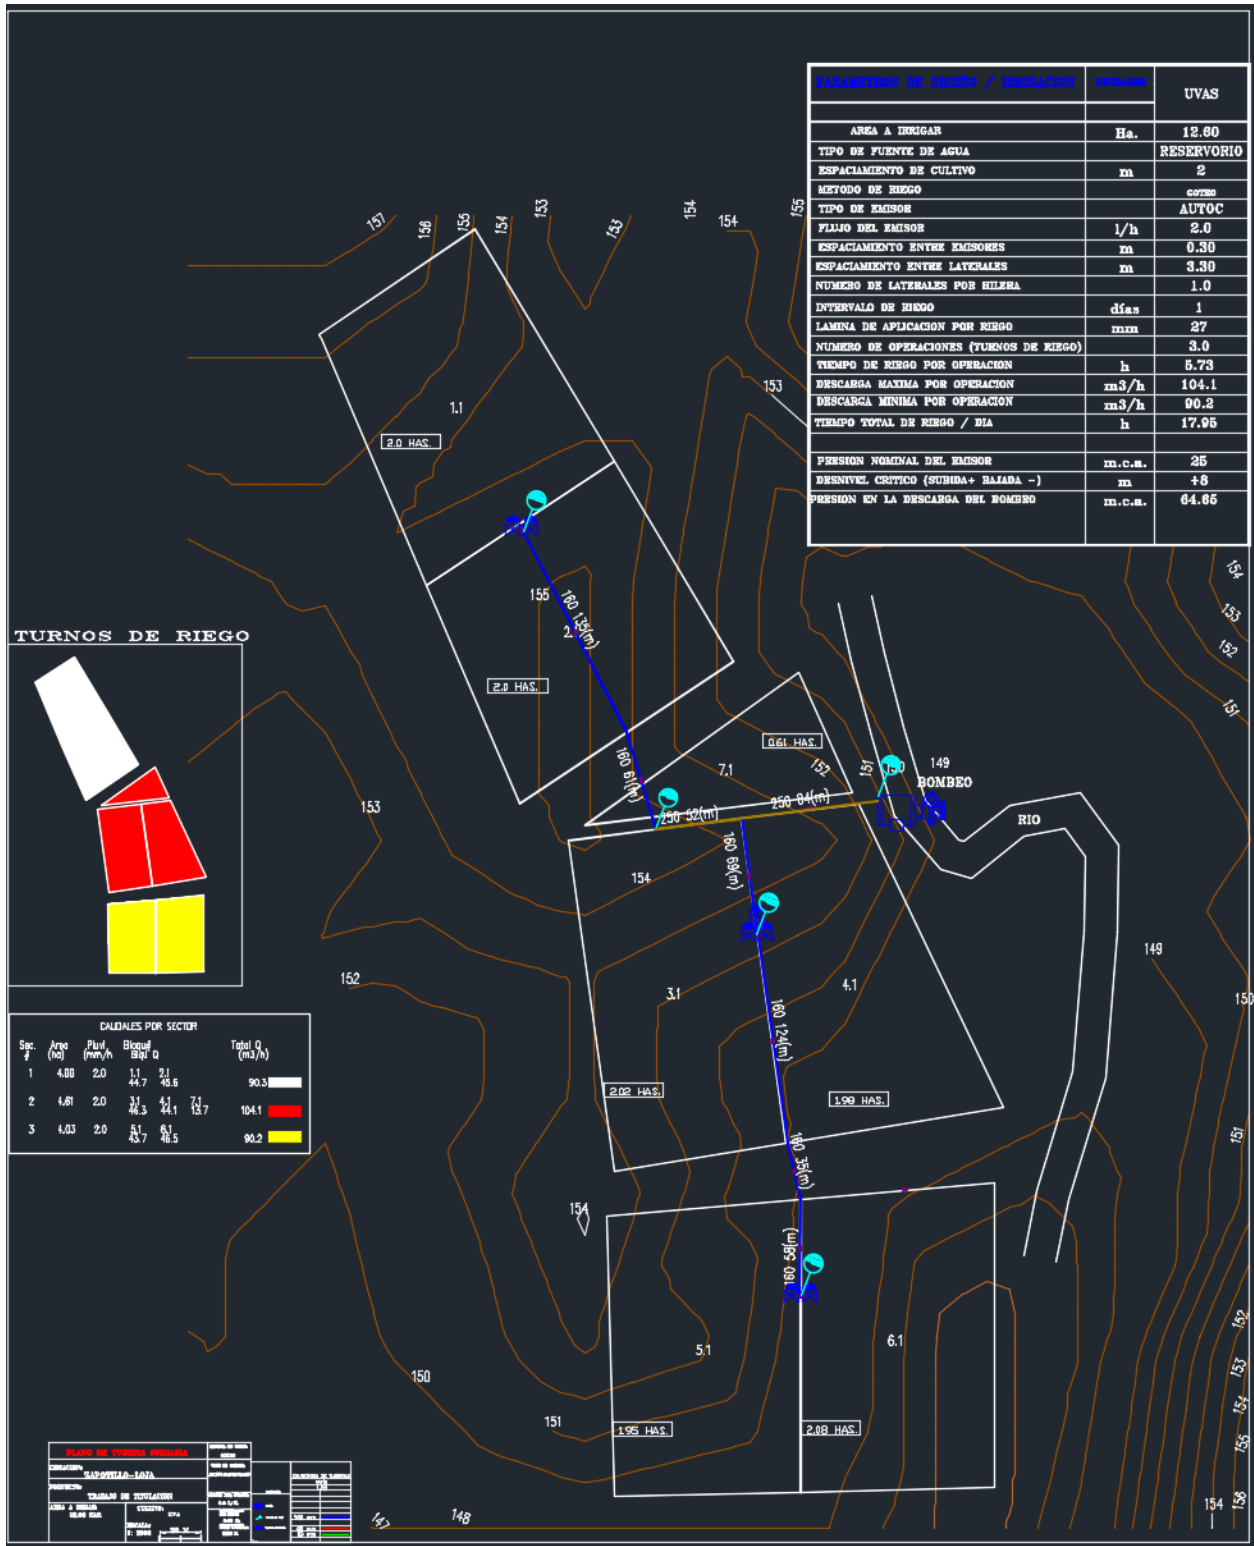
Plano de diseño de riego (Tubería primaria).
